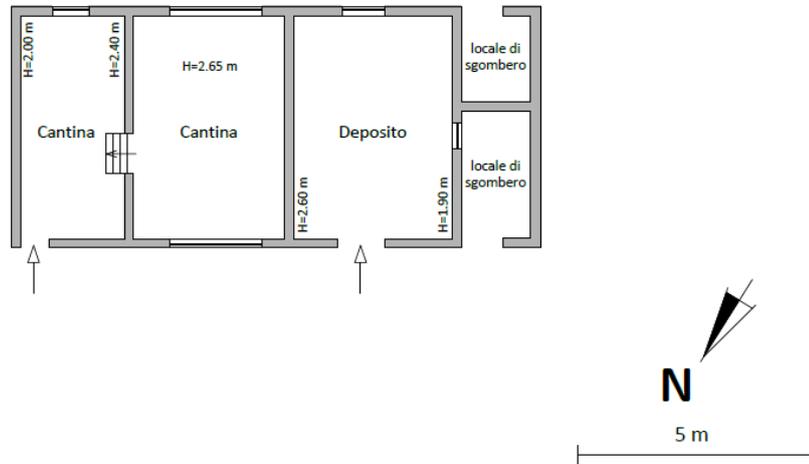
Planimetria dello stato reale dei luoghi - Piano Terra
